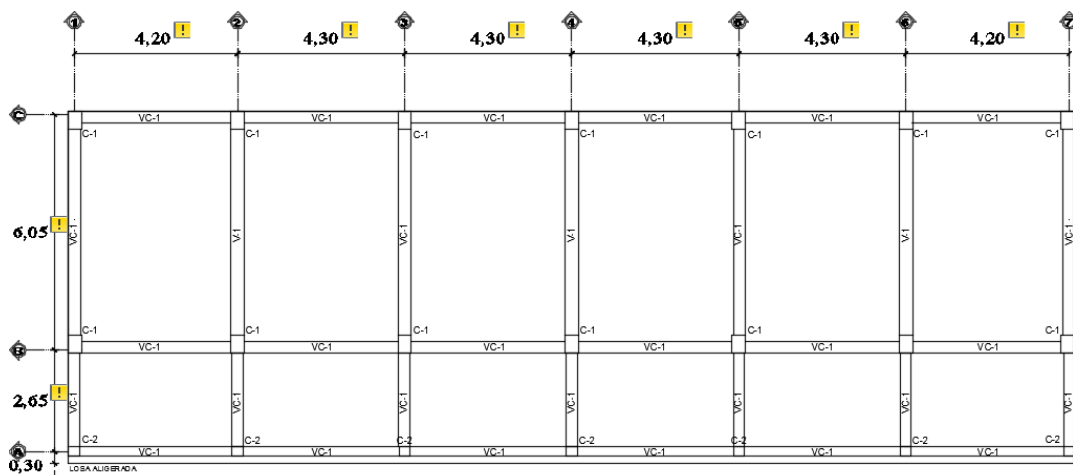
Vista planta de la distribución de los elementos estructurales de vigas y columnas
